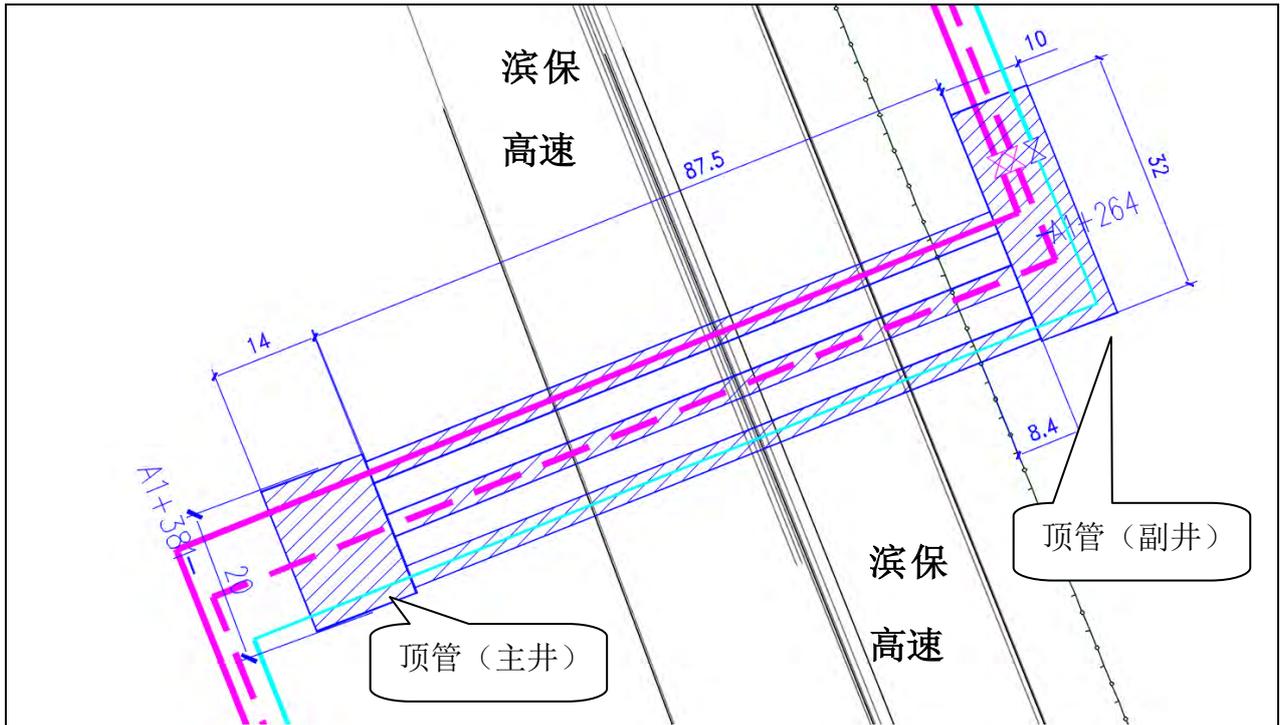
桩号 A1+264-A1+381 顶管工程管线变更平面图
